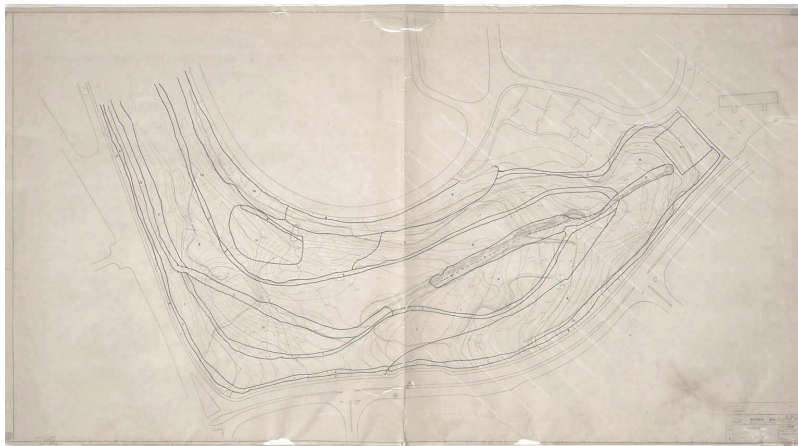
Célula C. Zona do Parque. Plano de zonamento da plantação. s.a, 1967.
